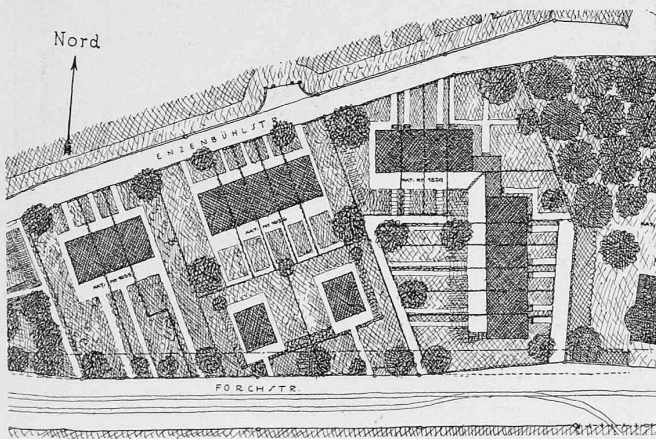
Einfamilienhäuser Rehalp, Zürich. — Lageplan 1:1500.
